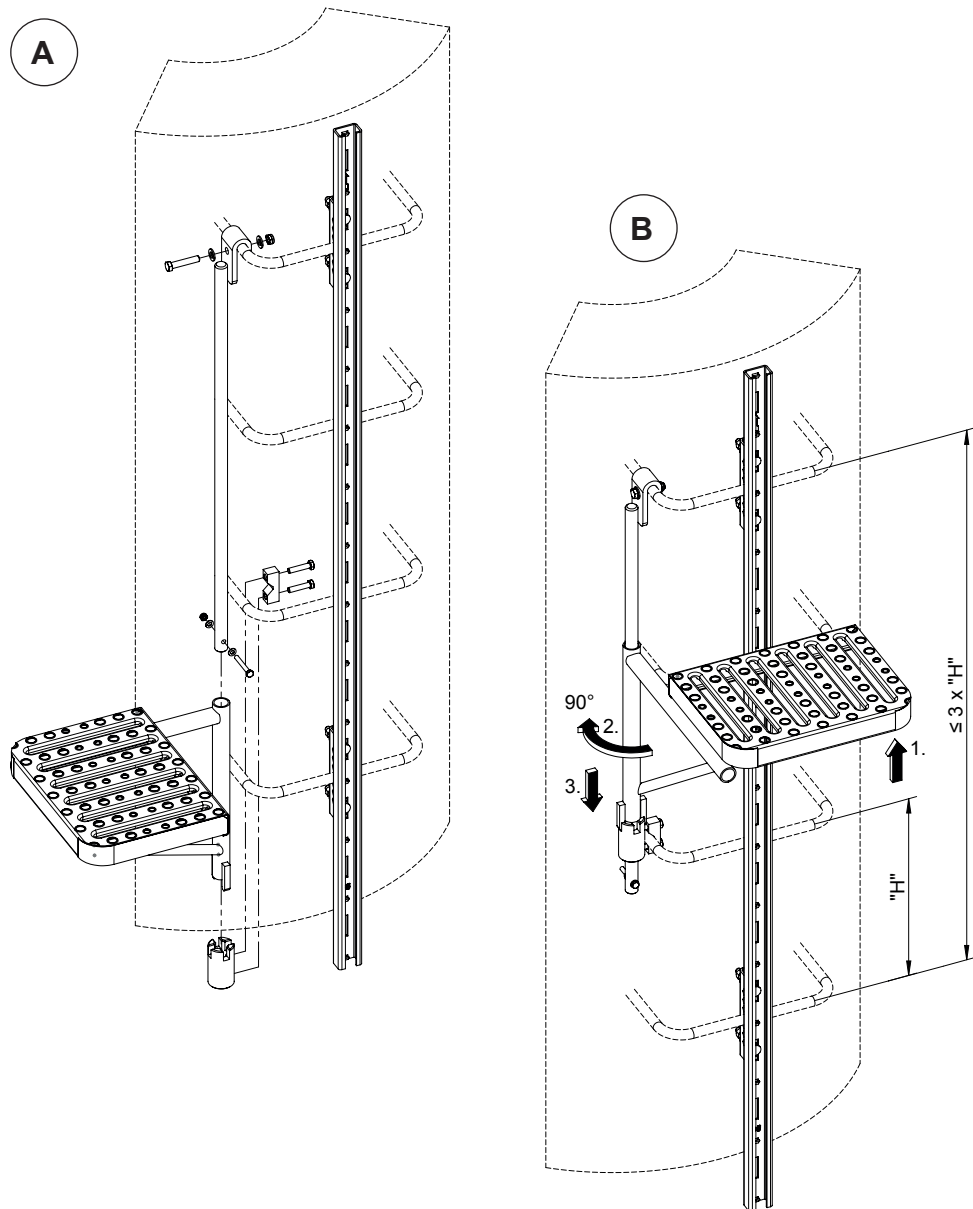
A: Repose-pieds pivotant de l'assemblage
